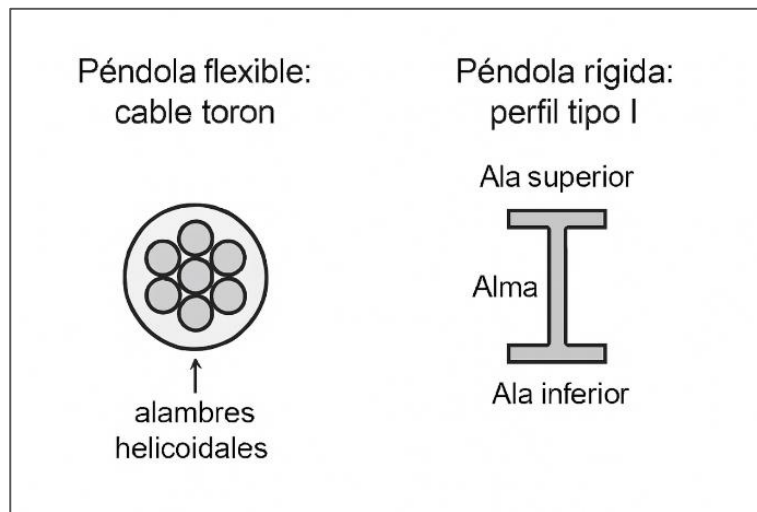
Corte Transversal comparativo de un cable torón y un perfil rígido. Fuente: [8]
